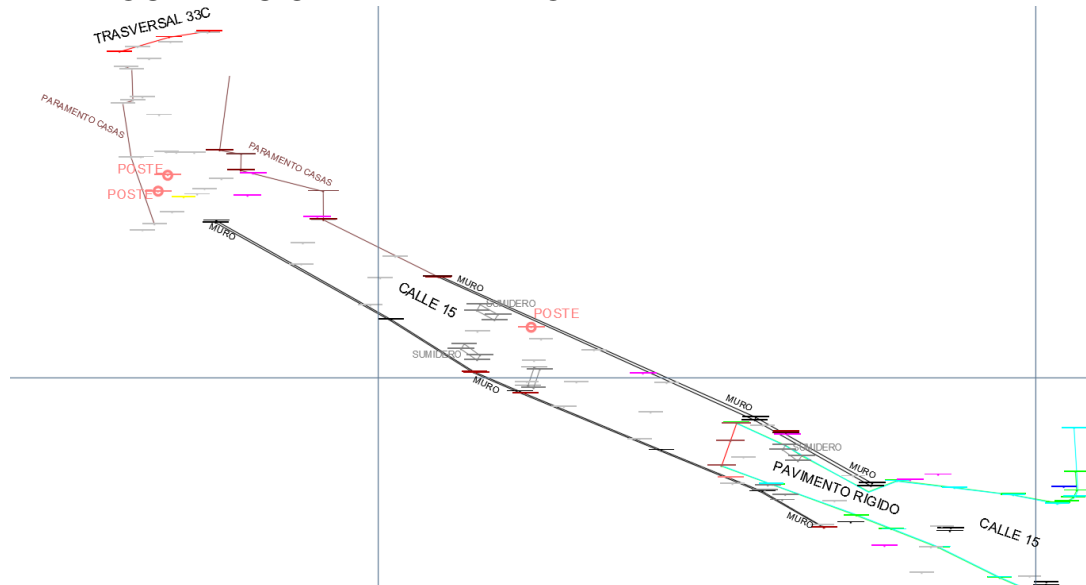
Plano levantamiento topográfico - Fuente: propia
